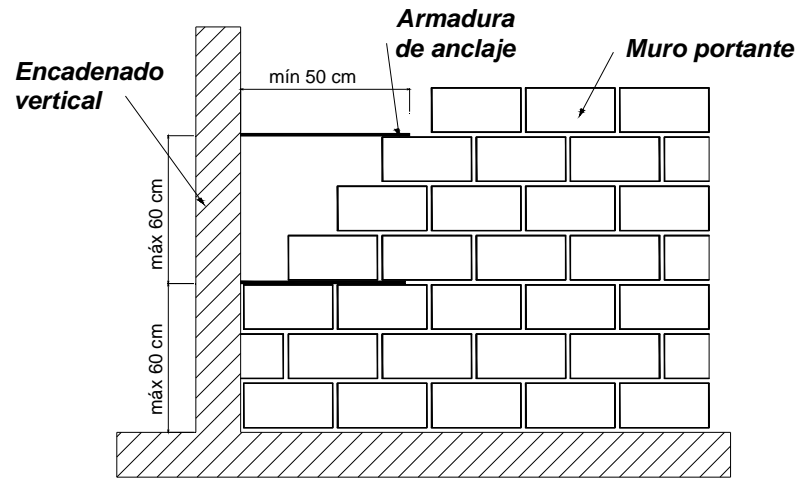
Armaduras de anclaje en encuentros de muros c/ 60 cm.
